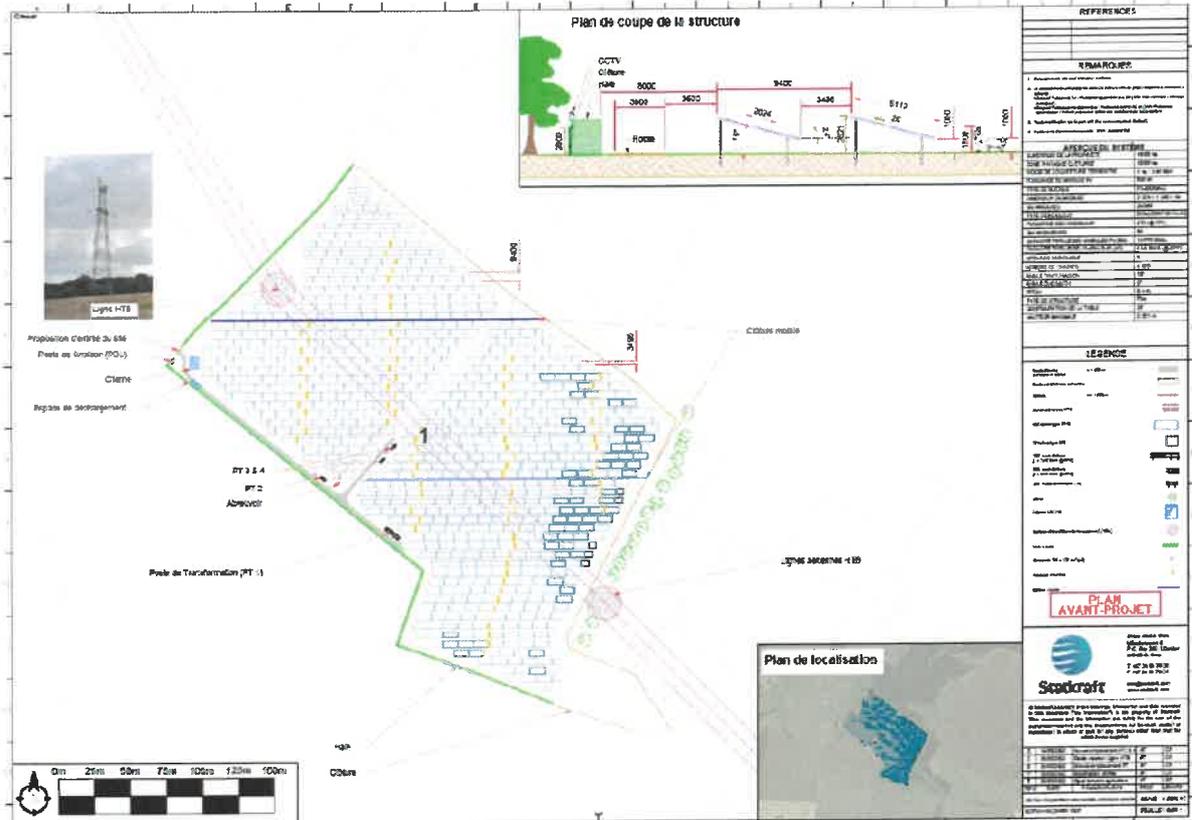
Plan de coupe des structures photovoltaïques avec la piste d'accès
